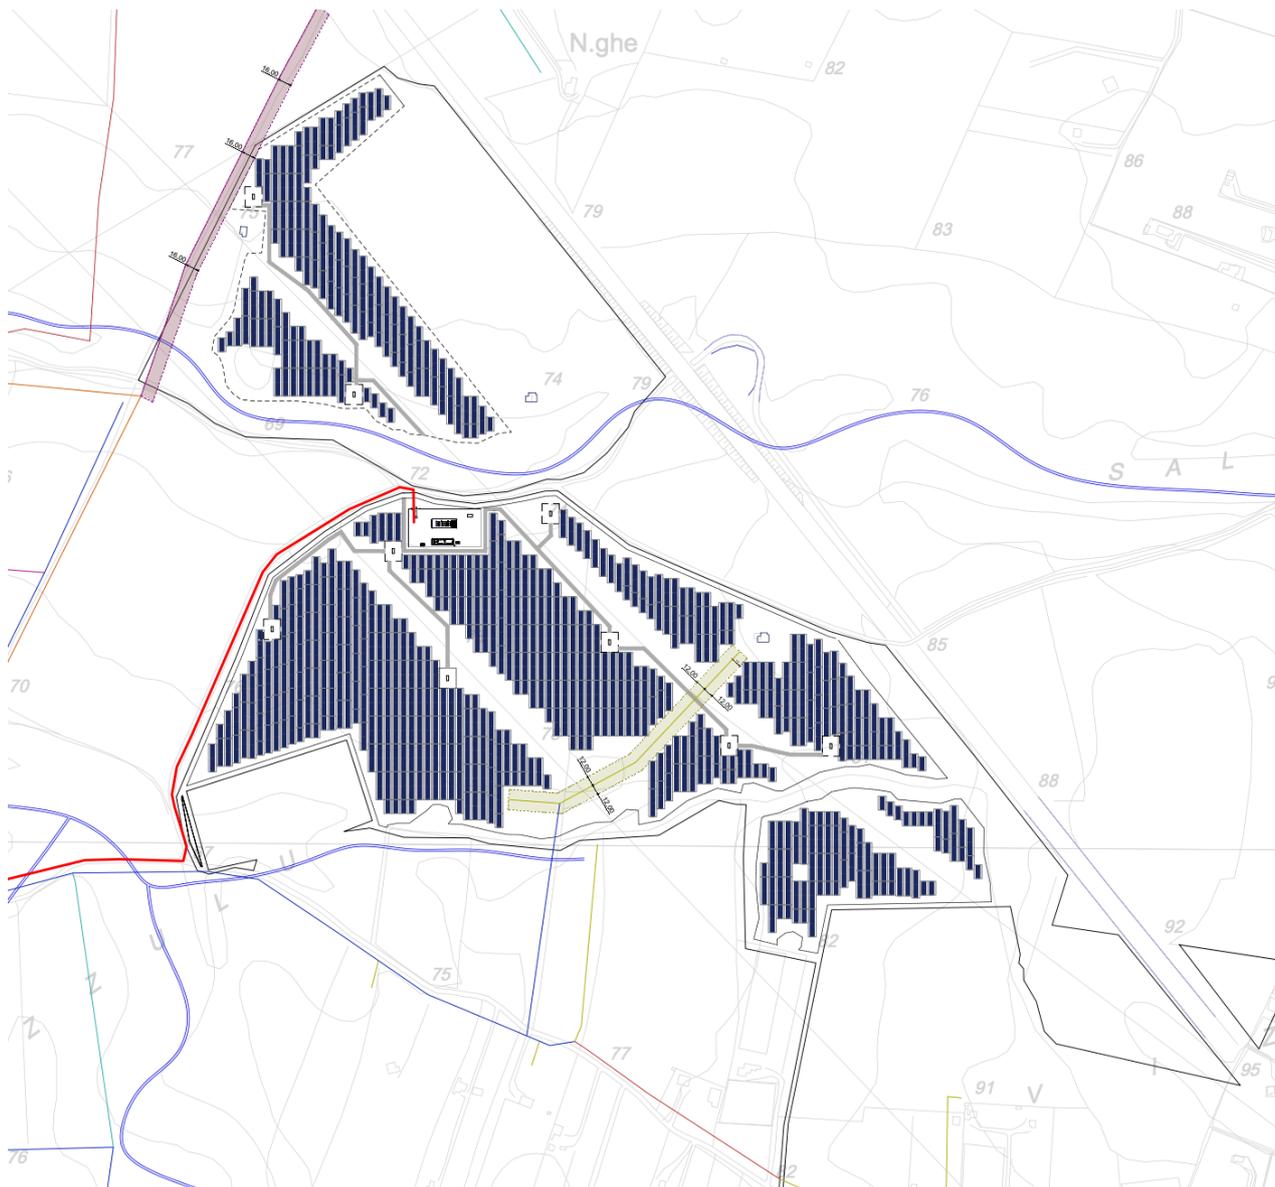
Estratto tavola OS\_12 B, “Sovrapposizione layout di impianto e cavidotto con la rete del Consorzio di Bonifica della Nurra – CBN – Dettaglio area di impianto con fasce di rispetto”
